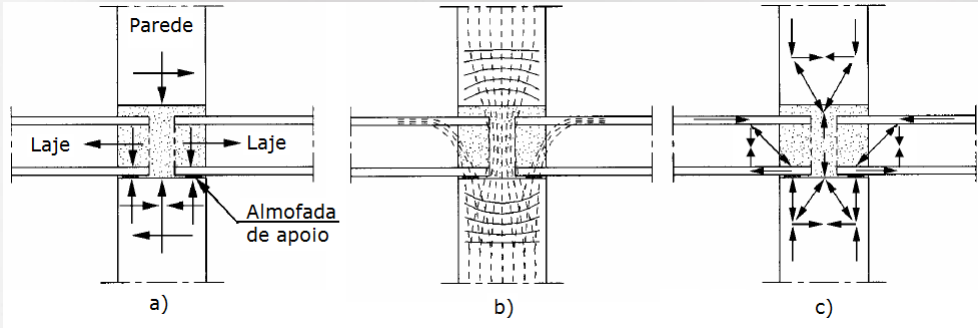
Exemplo de juntas horizontais em estruturas de painéis de paredes estruturais
